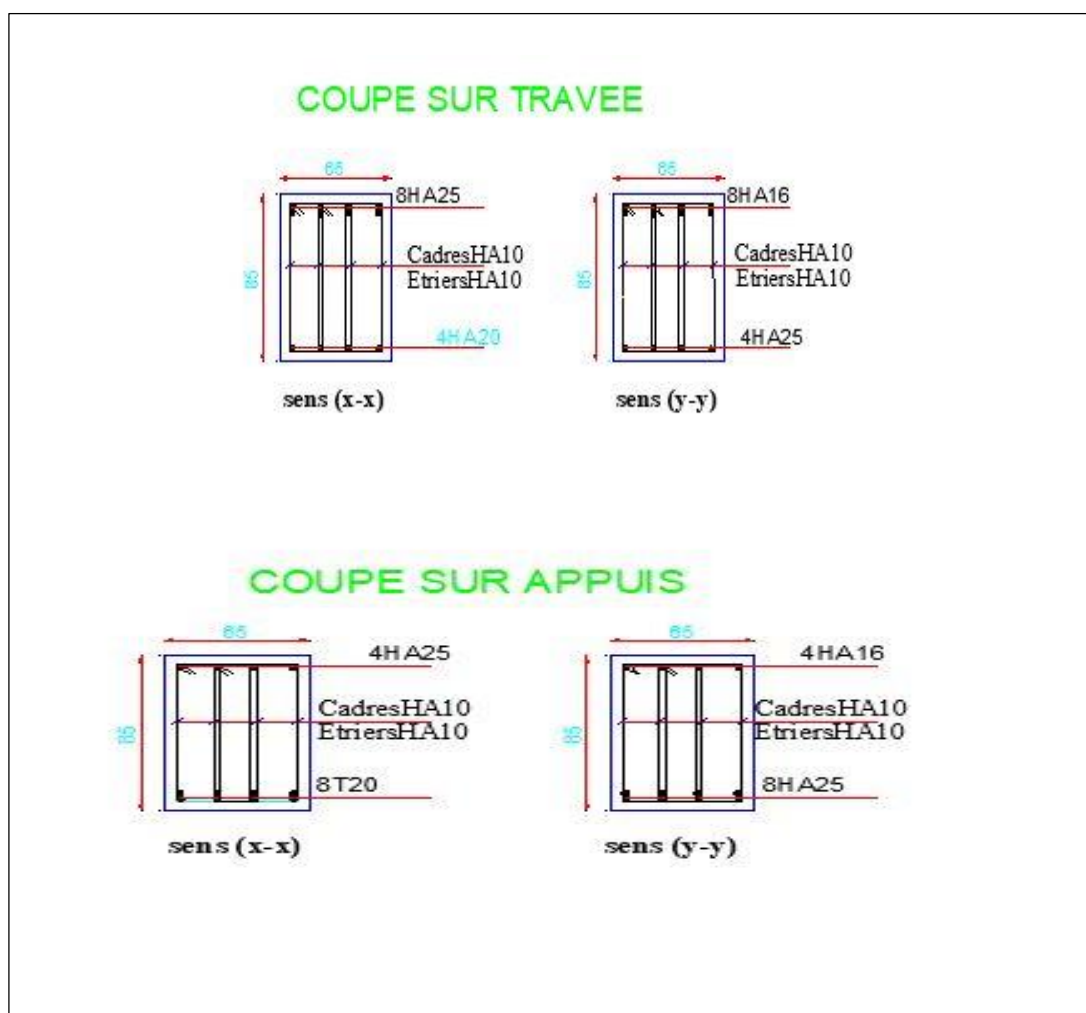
Ferrailage de la nervure en travées et en appuis
